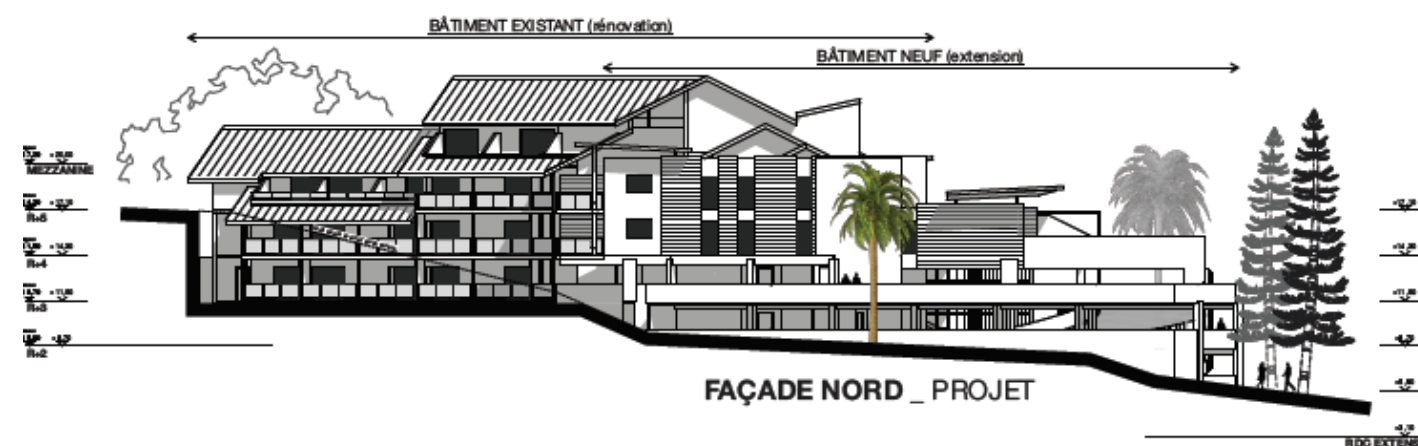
Façades Nord (Source : PC février 2020 – ARCHI 13)
